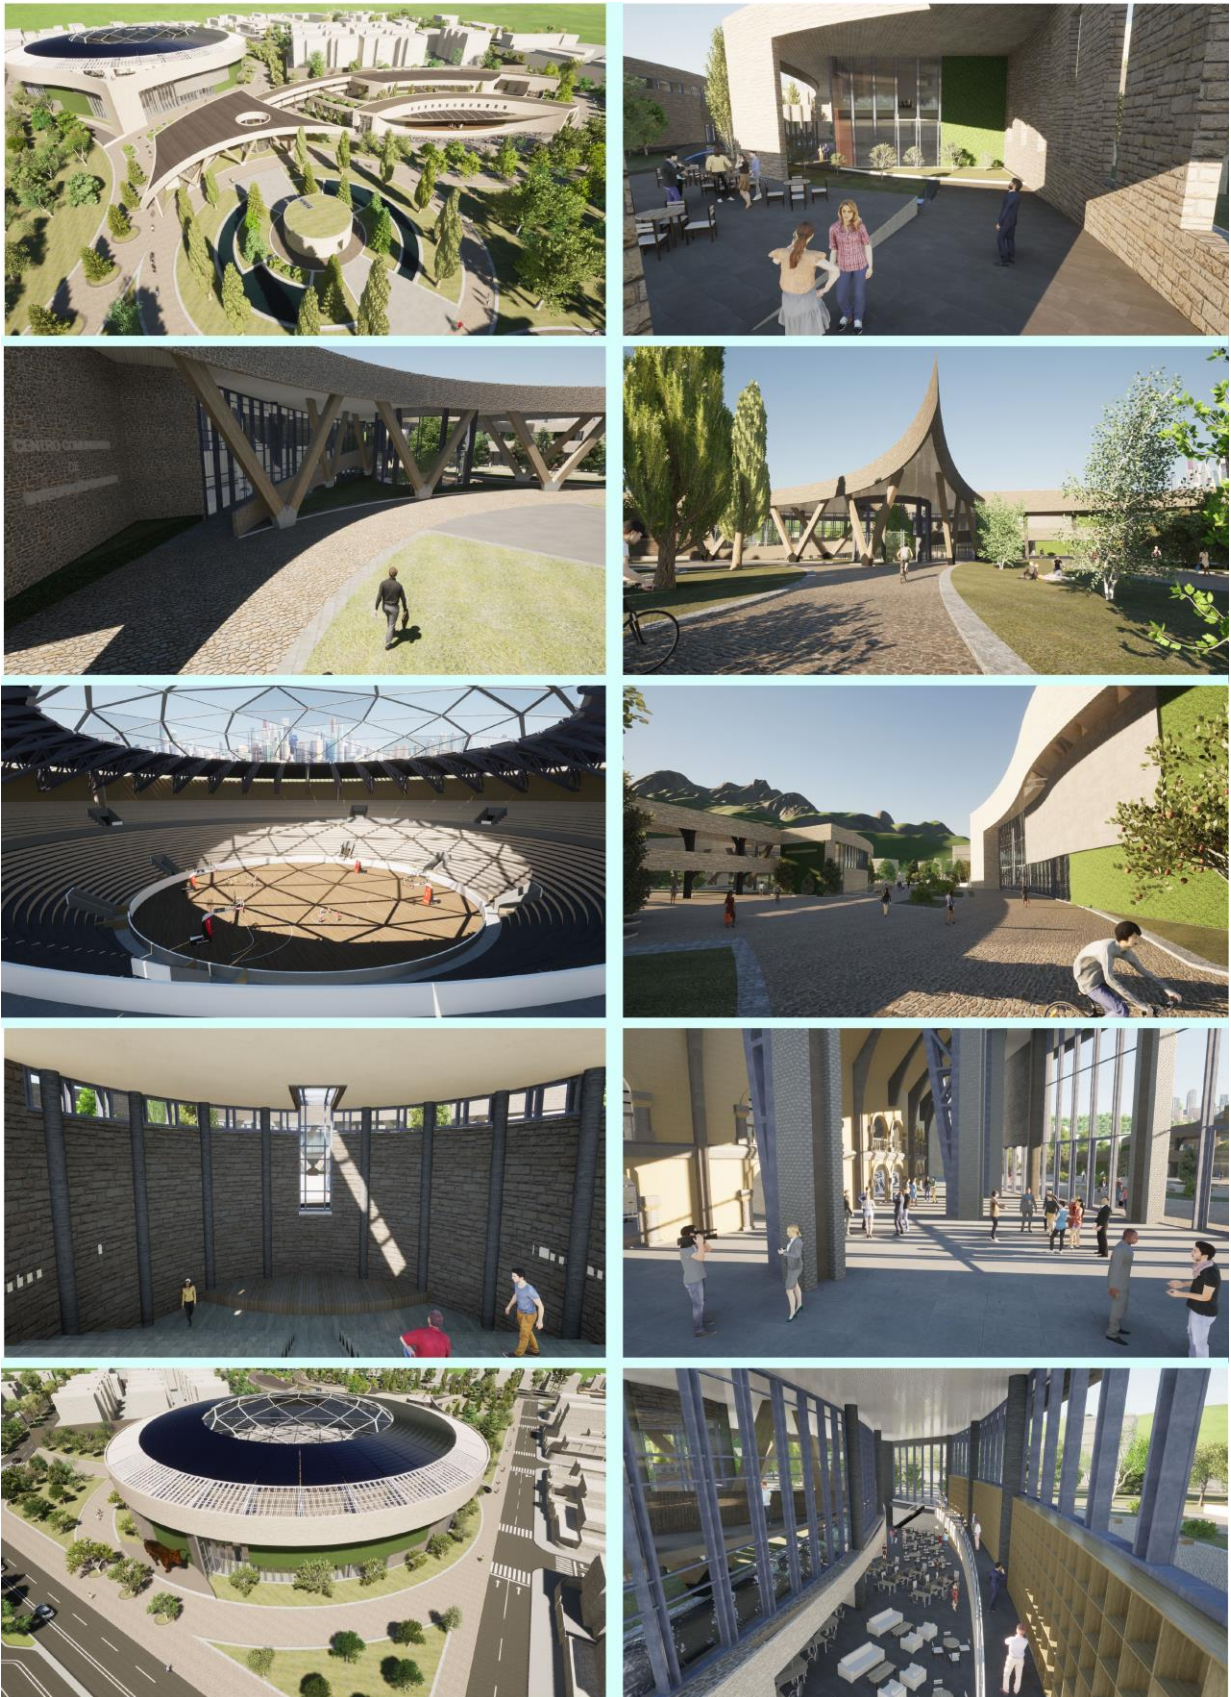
Vistas Interiores y Exteriores. Elaboración Propia.
